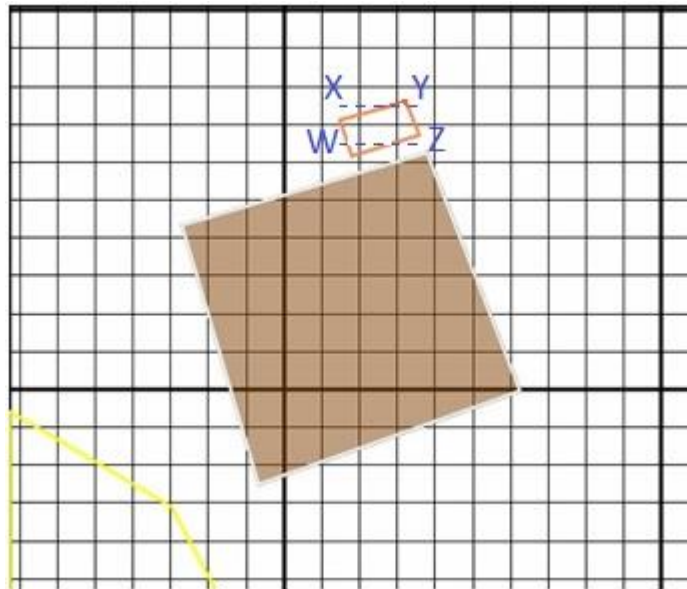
Vista em planta da localização da igreja (linha de cor vermelha) adjacente à escavação no modelo criado
